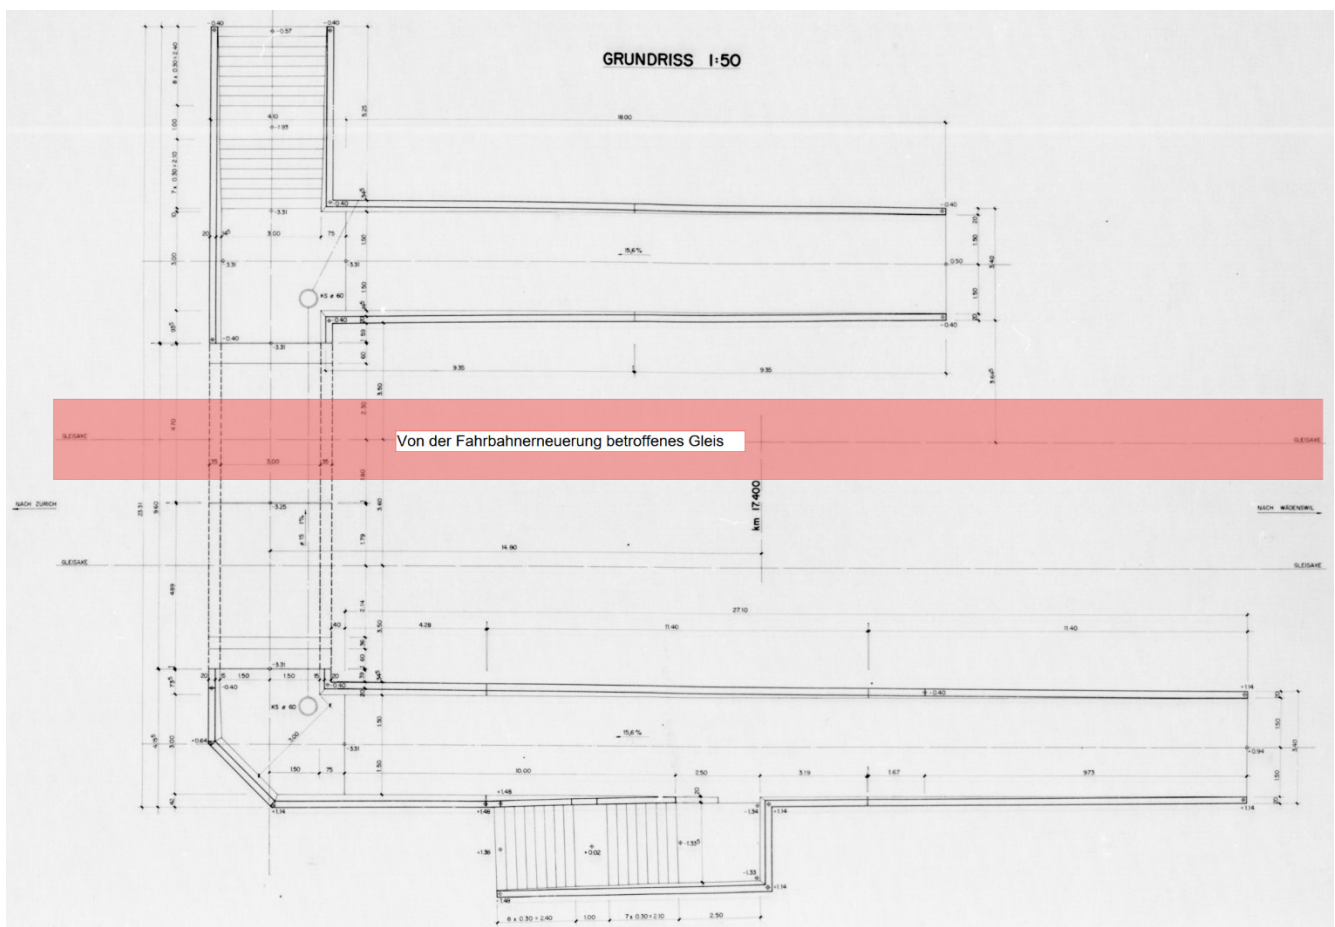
Grundriss PU und Rampenanfang
